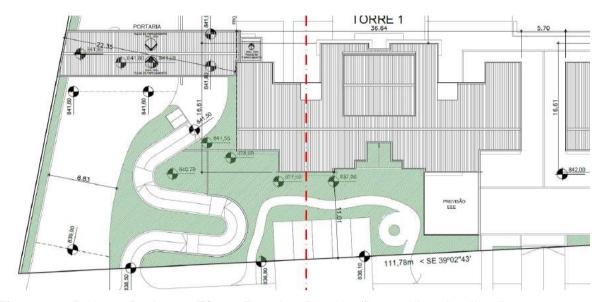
Projeto – Pavimento Térreo. Entrada e Portaria. (Para melhor visualização ver anexo correspondente).
